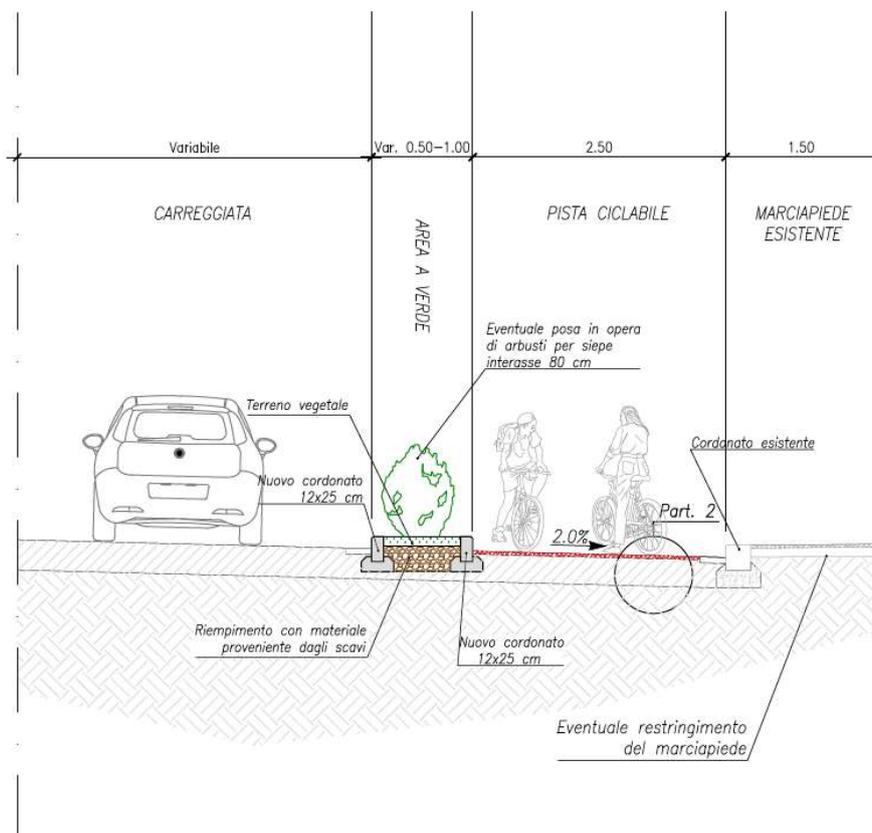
Sezione tipo 3: Pista ciclabile a quota stradale con separazione
